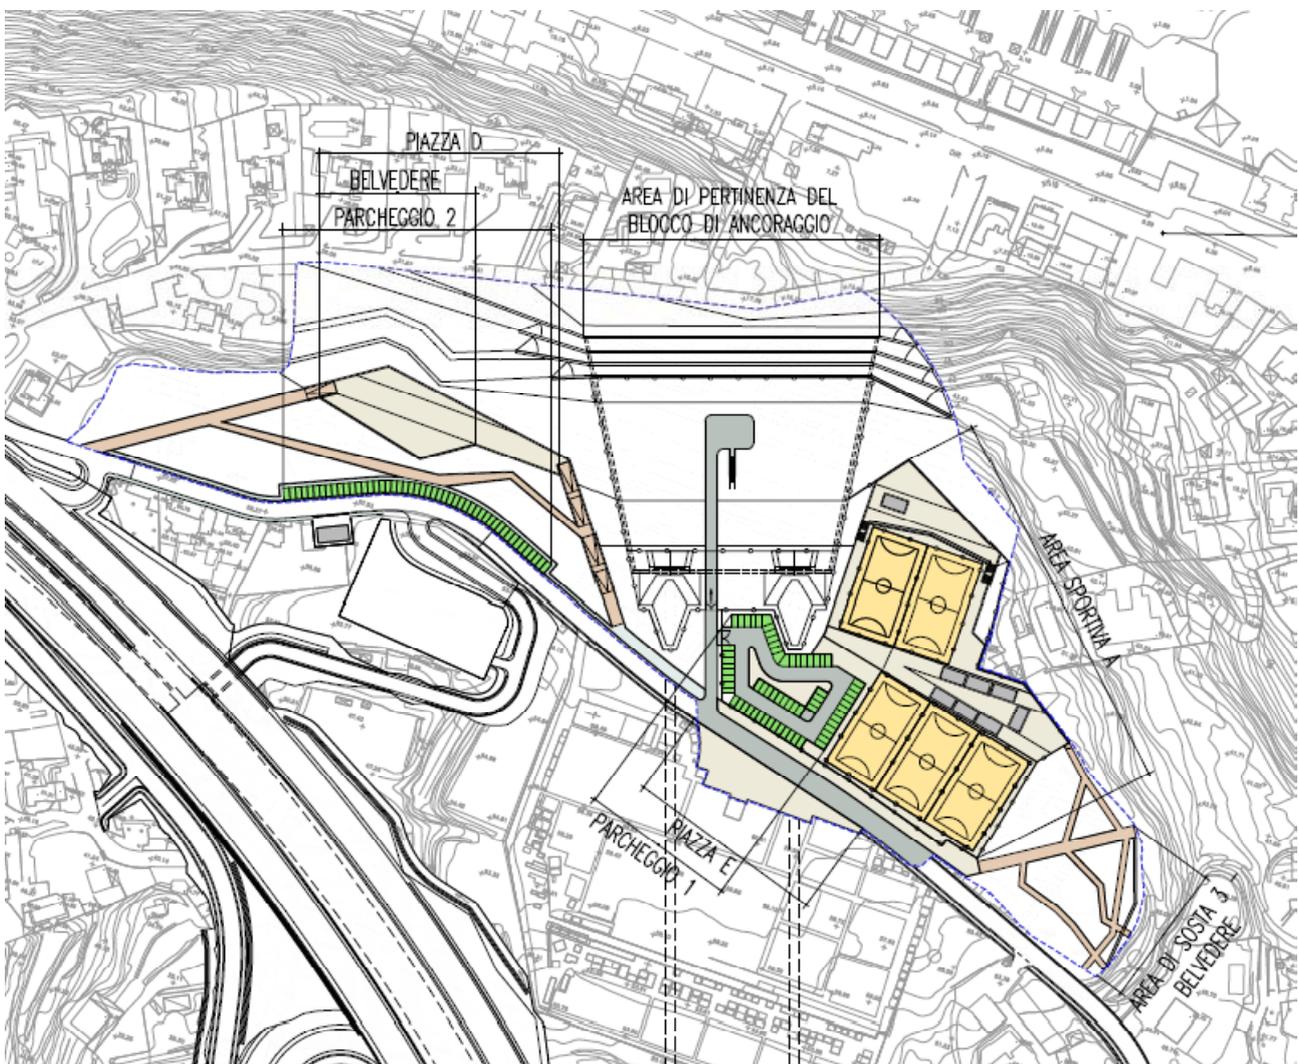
Assetto funzionale dell'ambito di progetto
